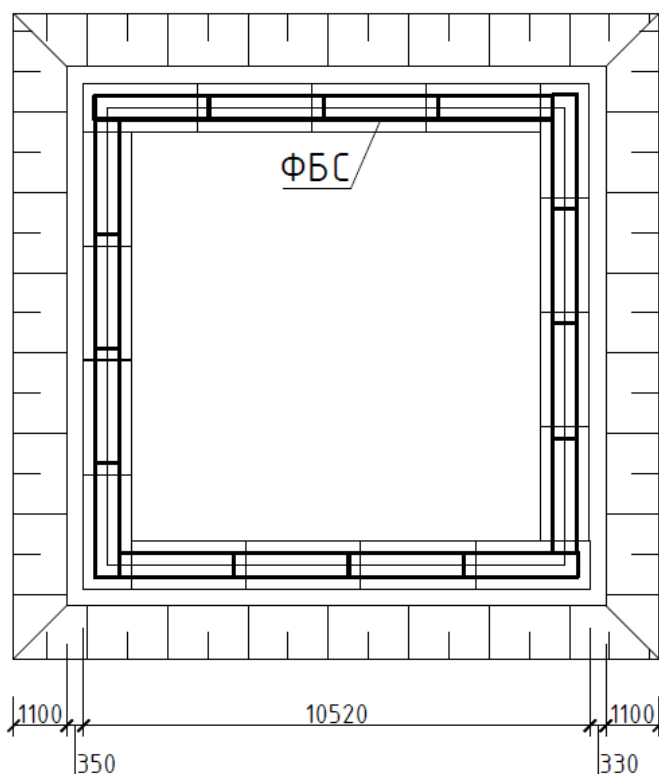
План раскладки плит ФБС 24-5-6т
